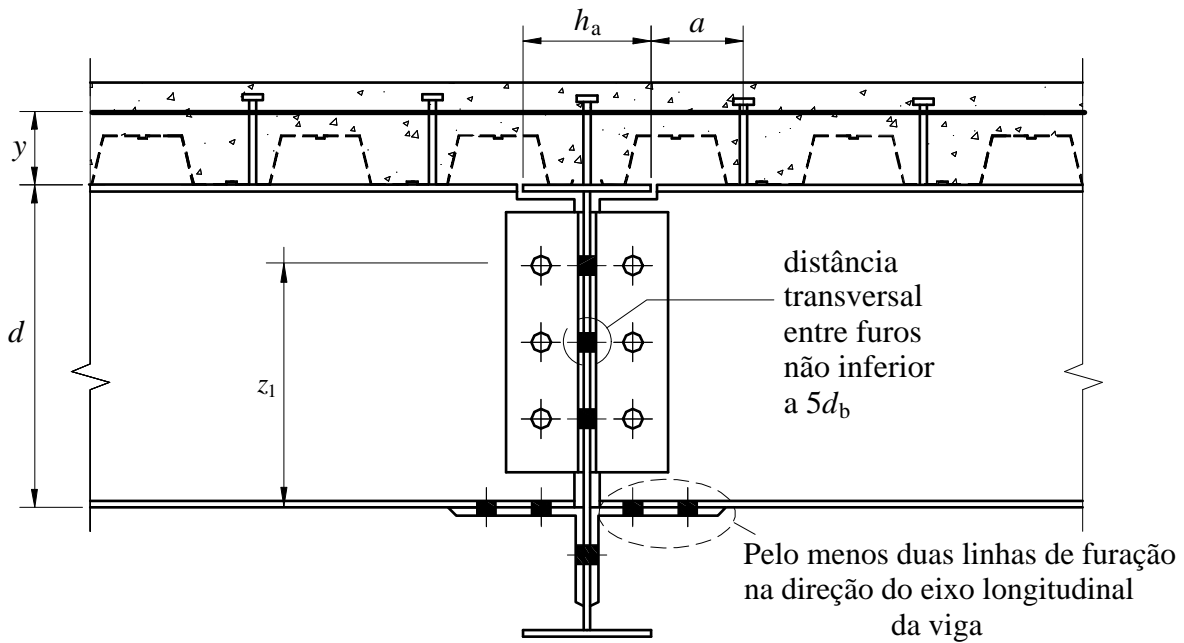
Ligação mista com cantoneiras parafusadas na alma (duas por viga) e na mesa inferior da viga apoiada
